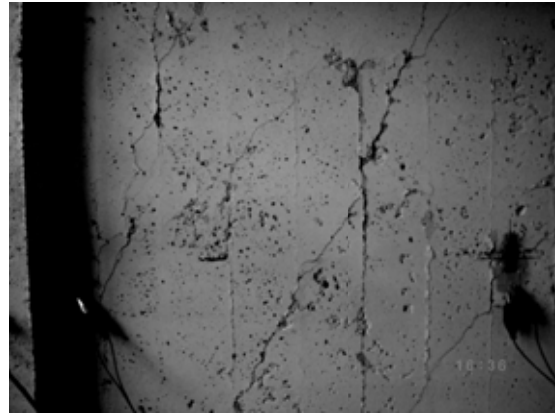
ひび割れ性状 (Fc7W-2)
